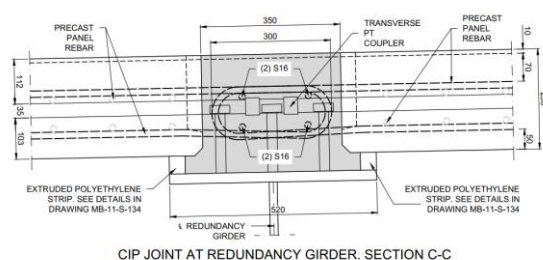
Sección en la junta entre paneles sobre las vigas de redundancia.
